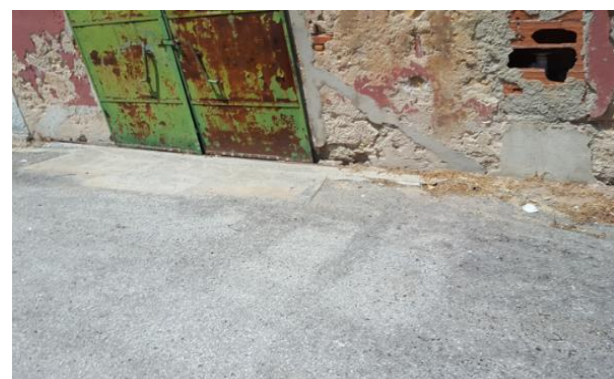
Destacamento de rebocos em fachada, fonte: Autor
